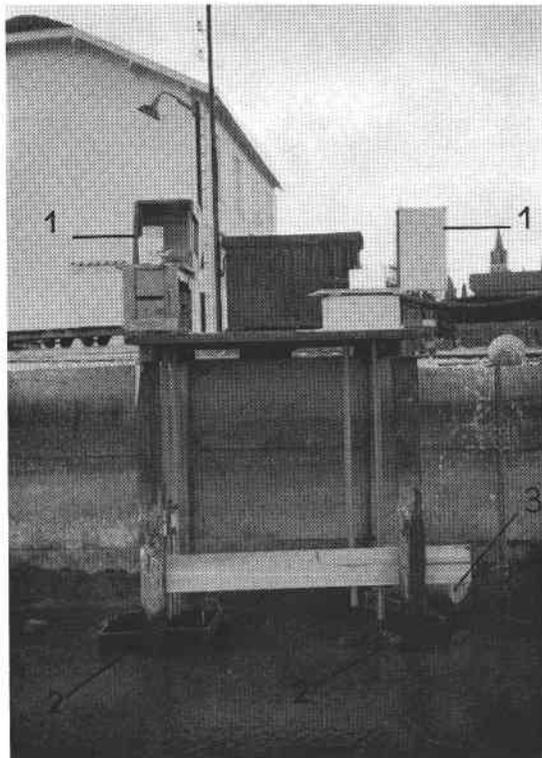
Vue d'ensemble du dispositif expérimental.
